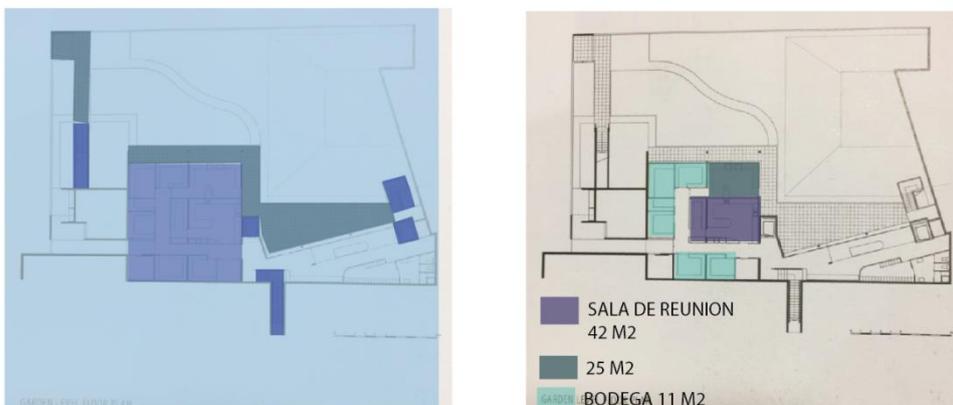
Planta Baja. Torcy. Fuente: libro Henri Ciriaini, 2016
